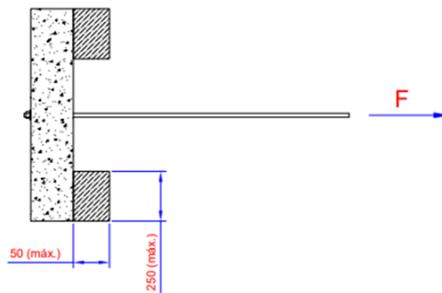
Posicionamento da placa de concreto para o ensaio.
